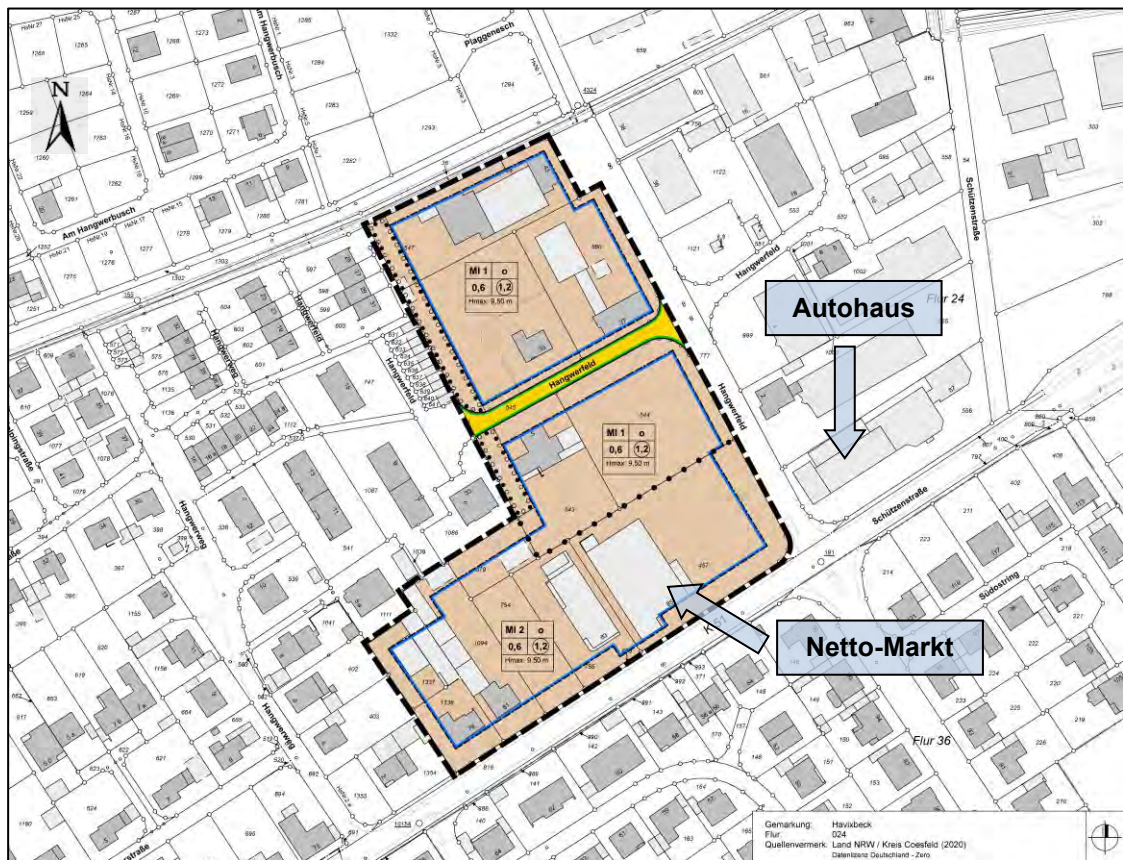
Planzeichnung zur Bebauungsplanänderung (Stand: 12.10.2020)
